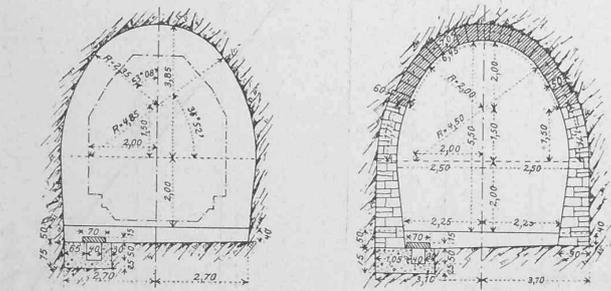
u. 5. Tunnelprofile zu Projekt I. — 1:200.
